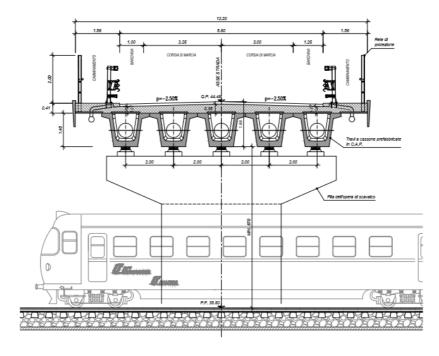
Cavalcaferrovia NW03 – Sezione trasversale impalcato
